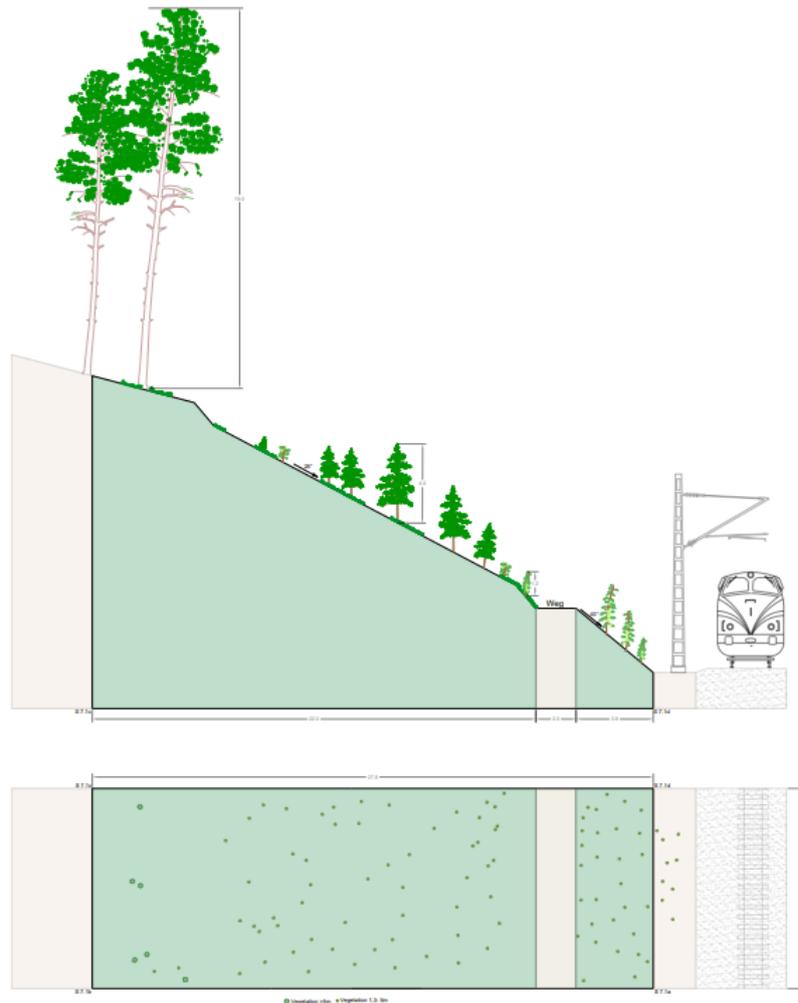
Fläche 7.1 – Querschnitt und Grundriss.
